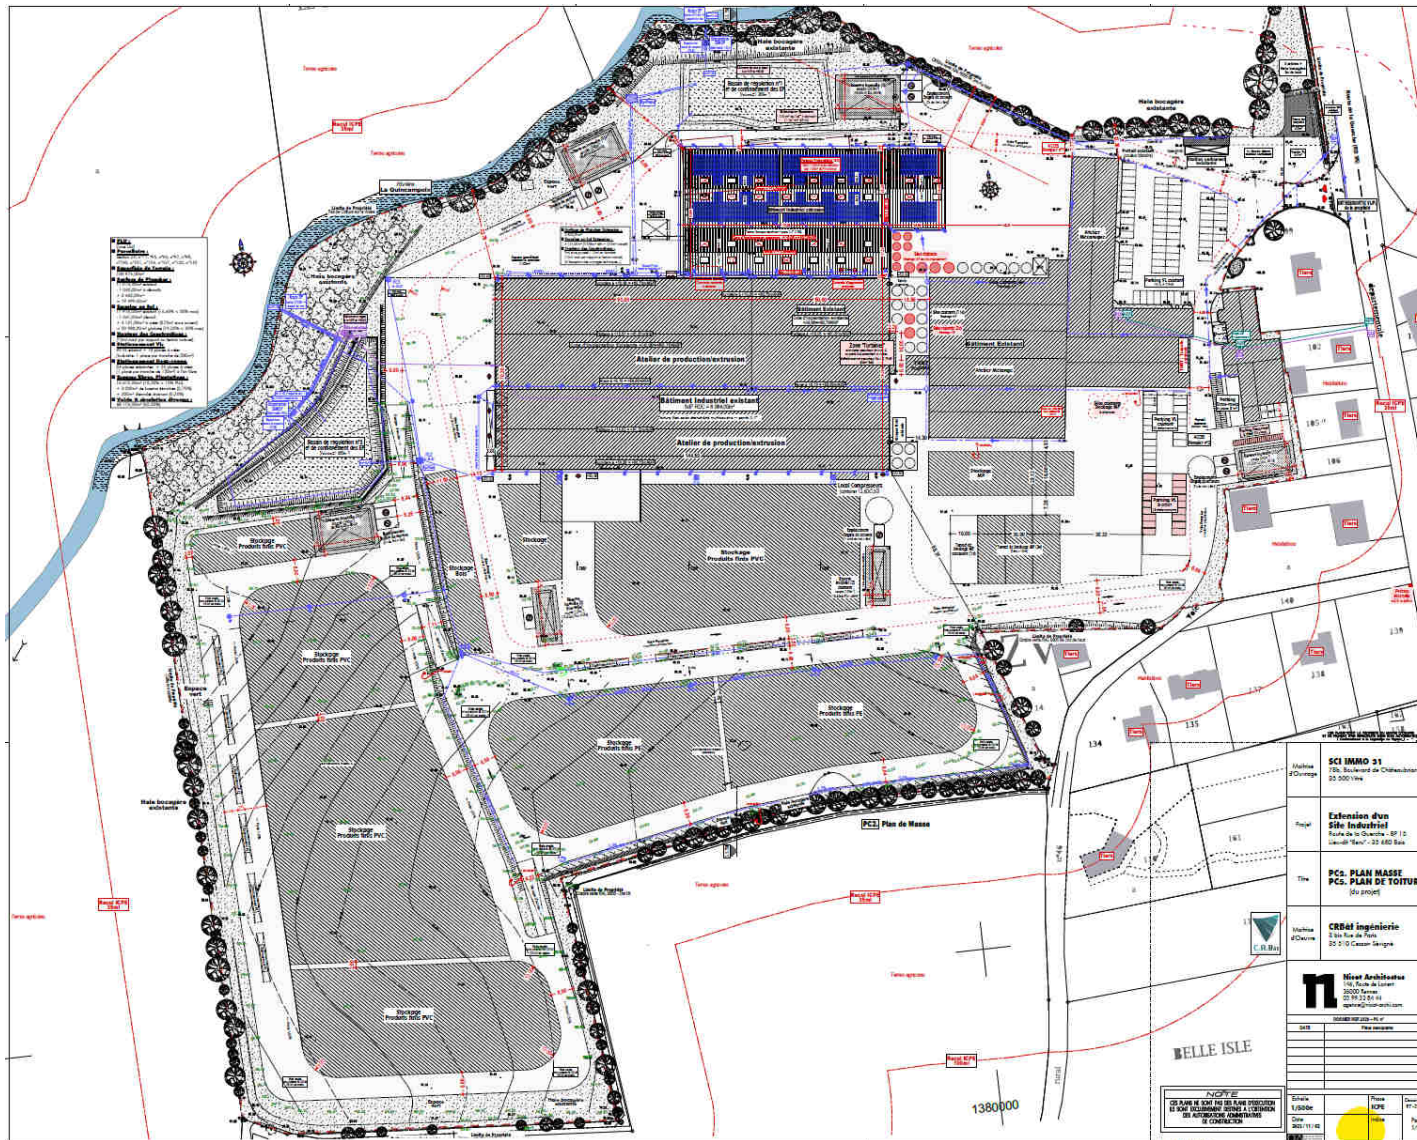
Plan d'ensemble (Source : Nicot Architecte)
